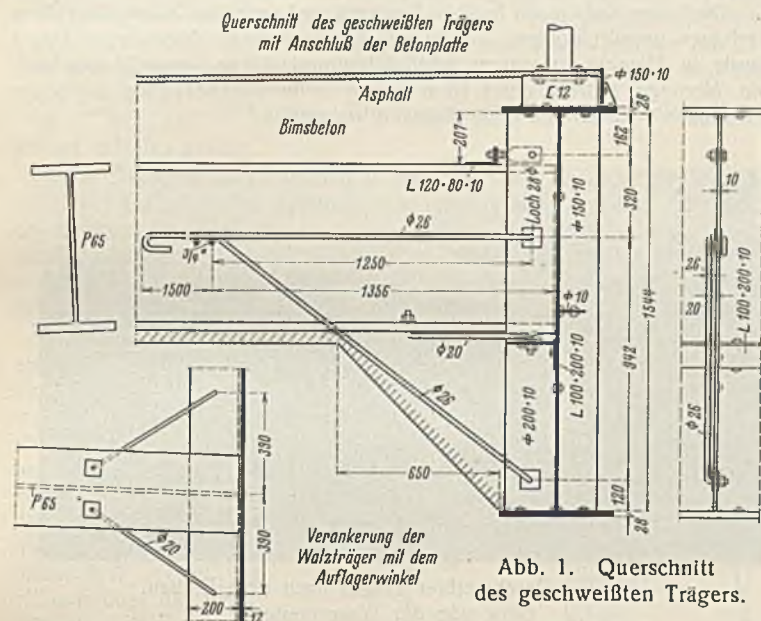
Querschnitt des geschweißten Trägers.
